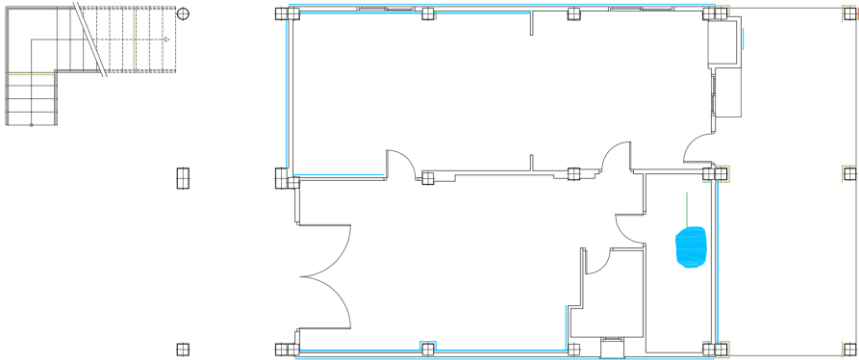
Mapeo lesiones Planta baja. 2024. Fuente: Propia
